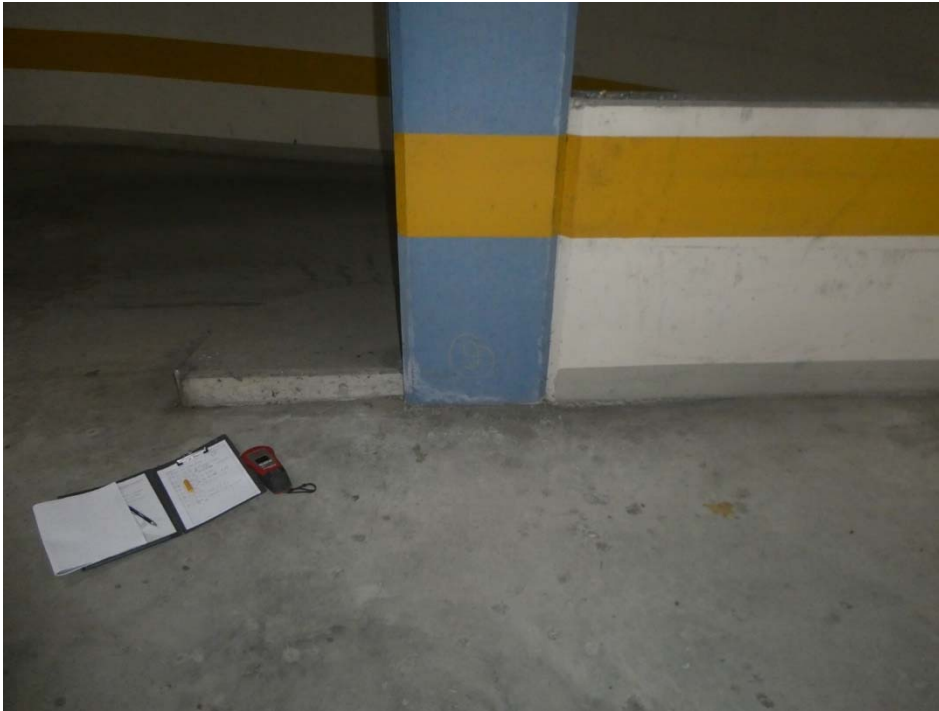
Untersuchungsstelle 9 – Stützensockel obere Parkebene neben Abfahrtsrampe
